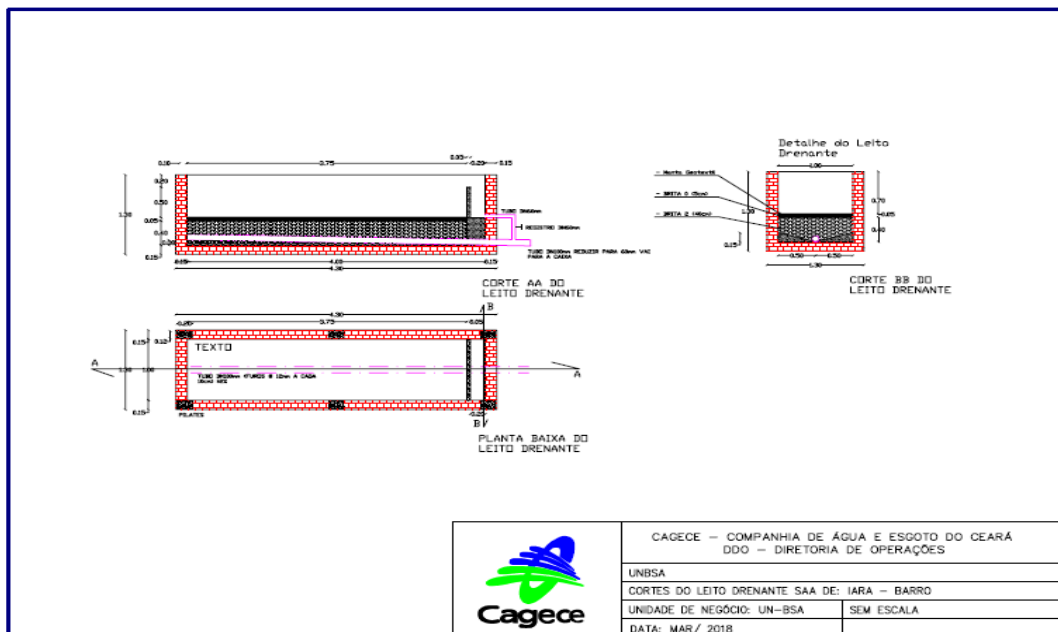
Planta Baixa e Corte da ETRG - Leitos Drenantes. Fonte: CAGECE.
